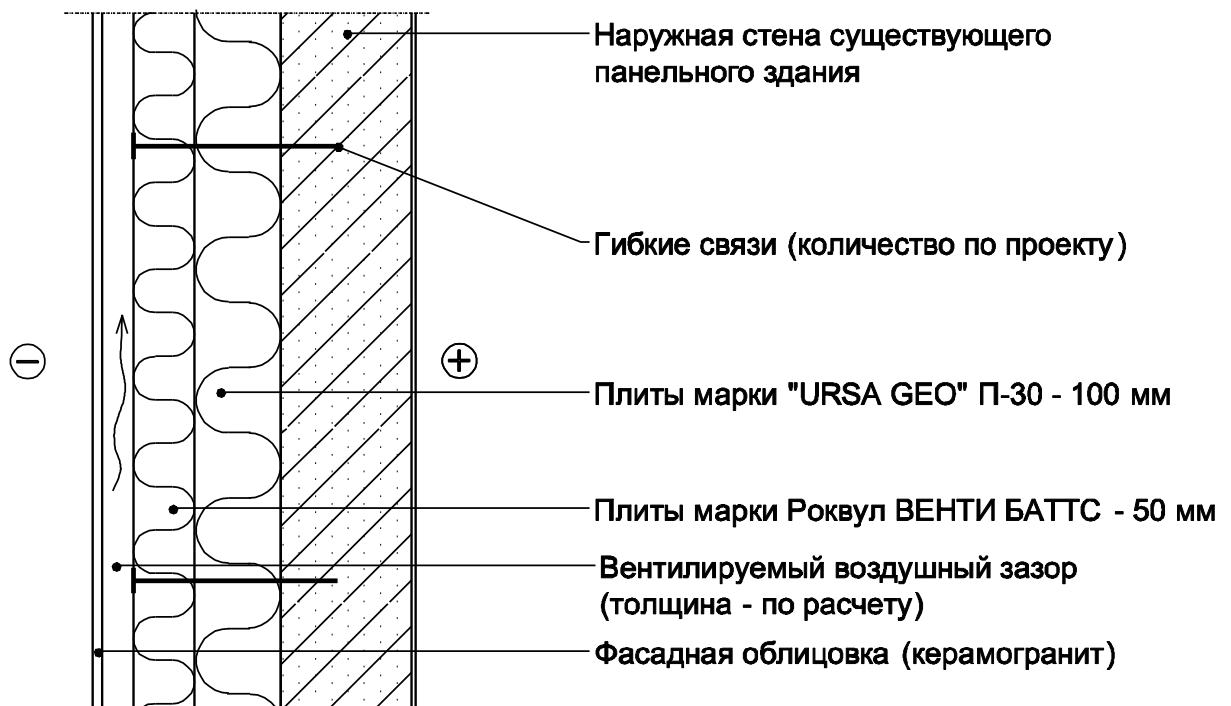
Схематичное изображение рассматриваемой конструкции наружной стены многоквартирного жилого панельного здания
